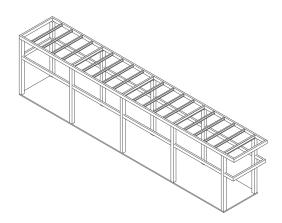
Axonometría estructural tipo 2_3 Fuente: Autores, 2024
